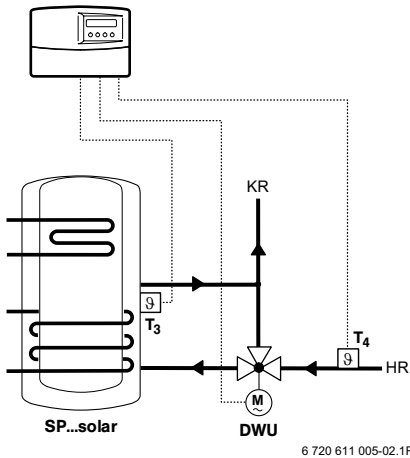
Anschluss-Schema solare Heizungsunterstützung
